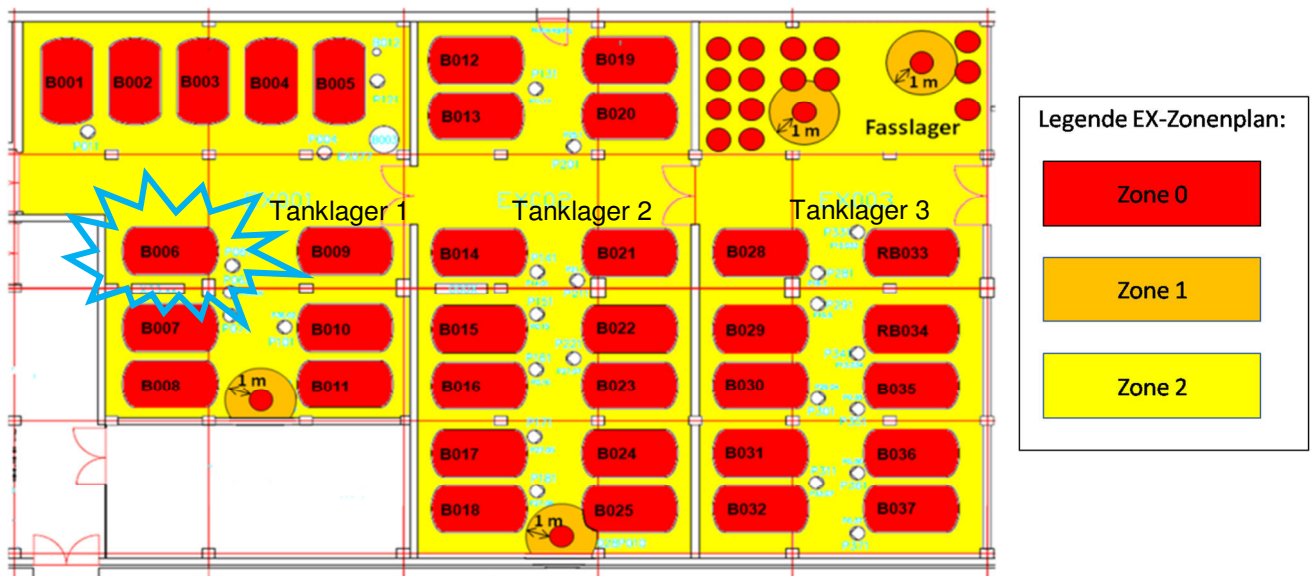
Zoneneinteilung Tanklager (Untergeschoss) – Darstellung des betroffenen Bereichs (blau) [49]
